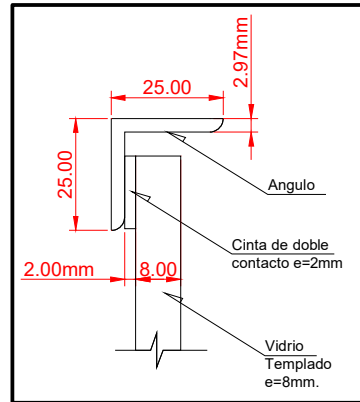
detalle los espesores de materiales utilizados en la construcción de la probeta de ensayo
